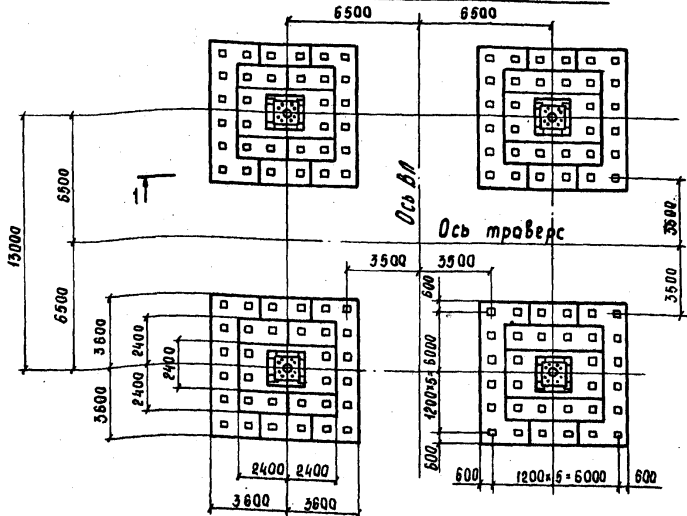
Отдельные блоки под каждую ногу опоры. Вариант фундамента со сборными плитами в основании.
